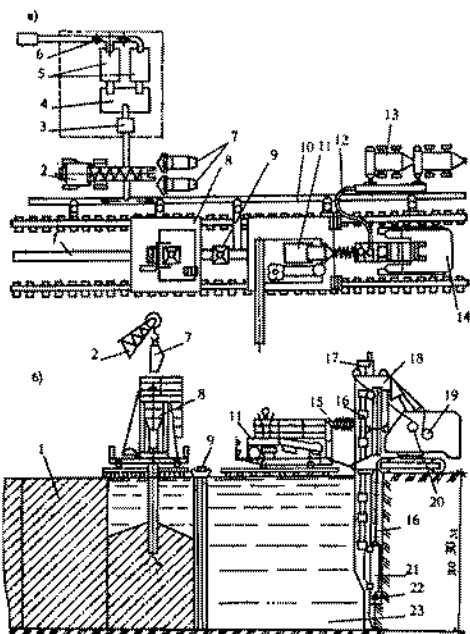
Схемы расположения оборудования (а) и производства работ при устройстве стен сооружений способом «стена в грунте» (б) 1 - забетонированный участок стены; 2 - кран грузоподъемностью 7 ... 10 т; 3 - грязевой насос; 4 - емкость для глинистого раствора (суспензии); 5 - смесители БС-2 для приготовления глинистых растворов; 6 - центробежный насос; 7 - бады; 8 - установка для заполнения траншеи бетоном; 9 - ограждающий шаблон; 10 - растворопровод; 11 - ситогидроциклонная установка; 12 - воздухопроводный шланг; 13 - компрессоры; 14 - гусеничный кран проходческого агрегата СВД-500; 15 - нульотводящий шланг; 16 - трос; 17 - направляющий шаблон; 18 - рама; 19 - лебедка подъема стрелы; 20 - грузовая лебедка; 21 - электробур; 22 - породоразрушающий инструмент; 23 - глинистая суспензия
